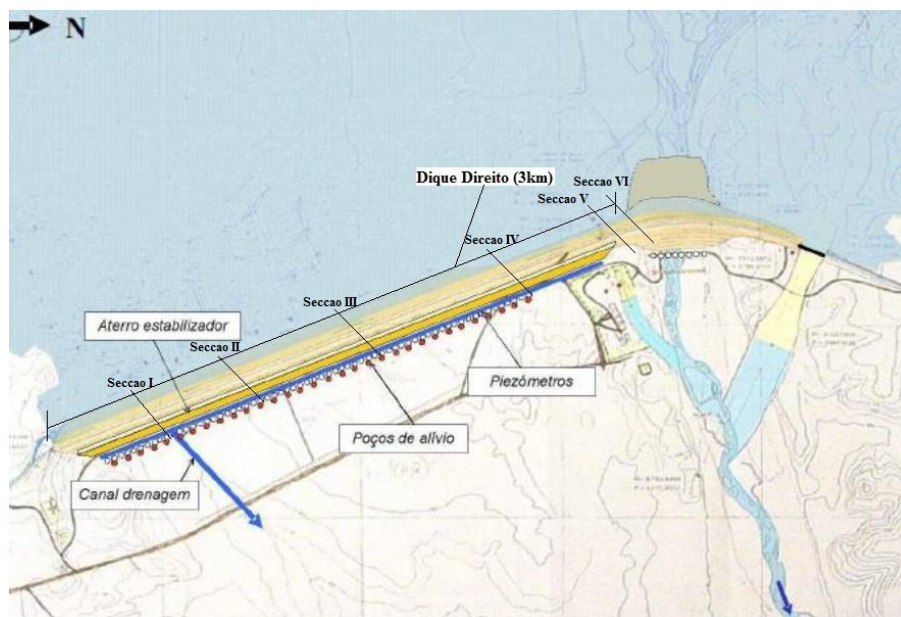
planta da barragem de Massingir, (XITIZAP, 2016)
